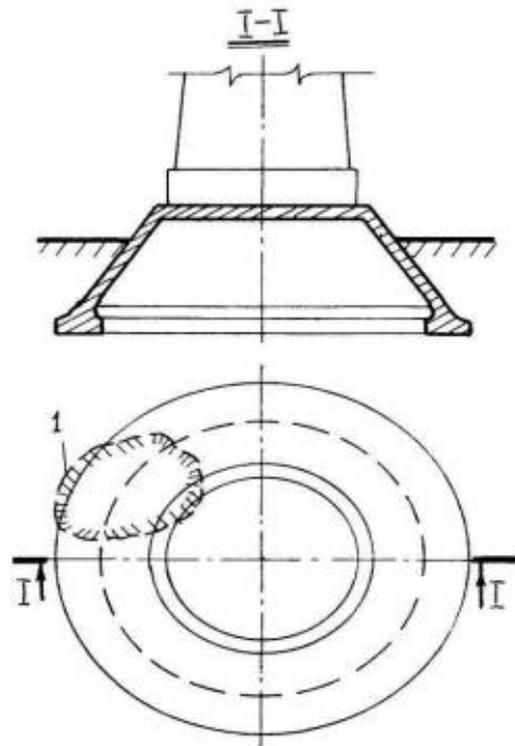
Фундамент із розосередженою кільцевою п'ятою спирання:
